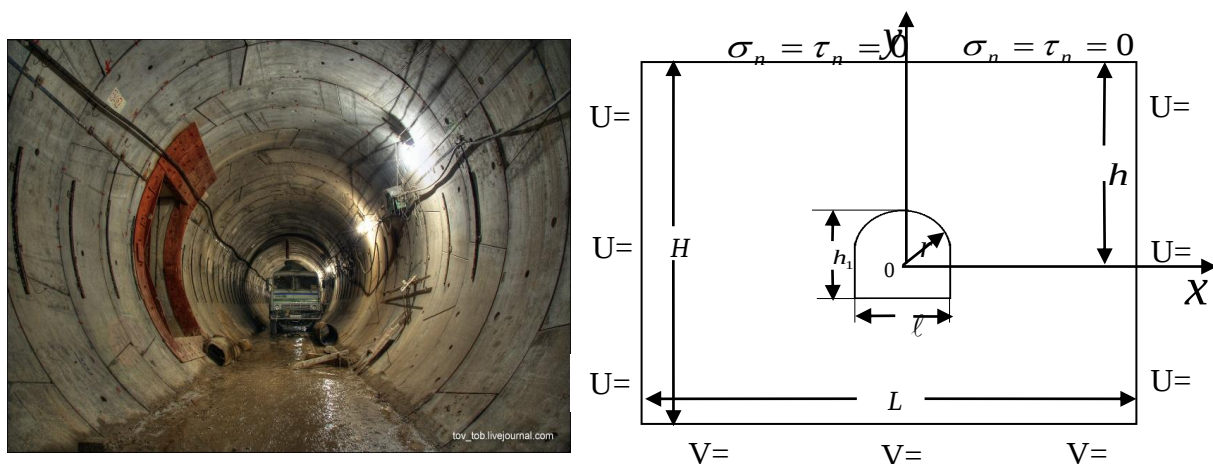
Сборная железобетонная обделка тоннеля после сборки (а) и ее расчетная схема (б).
